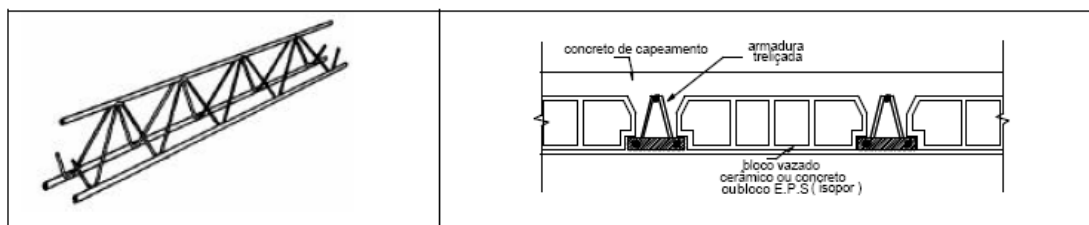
Armadura da laje pré-fabricada treliçada e seção transversal com o preenchimento entre as vigas e capeamento
